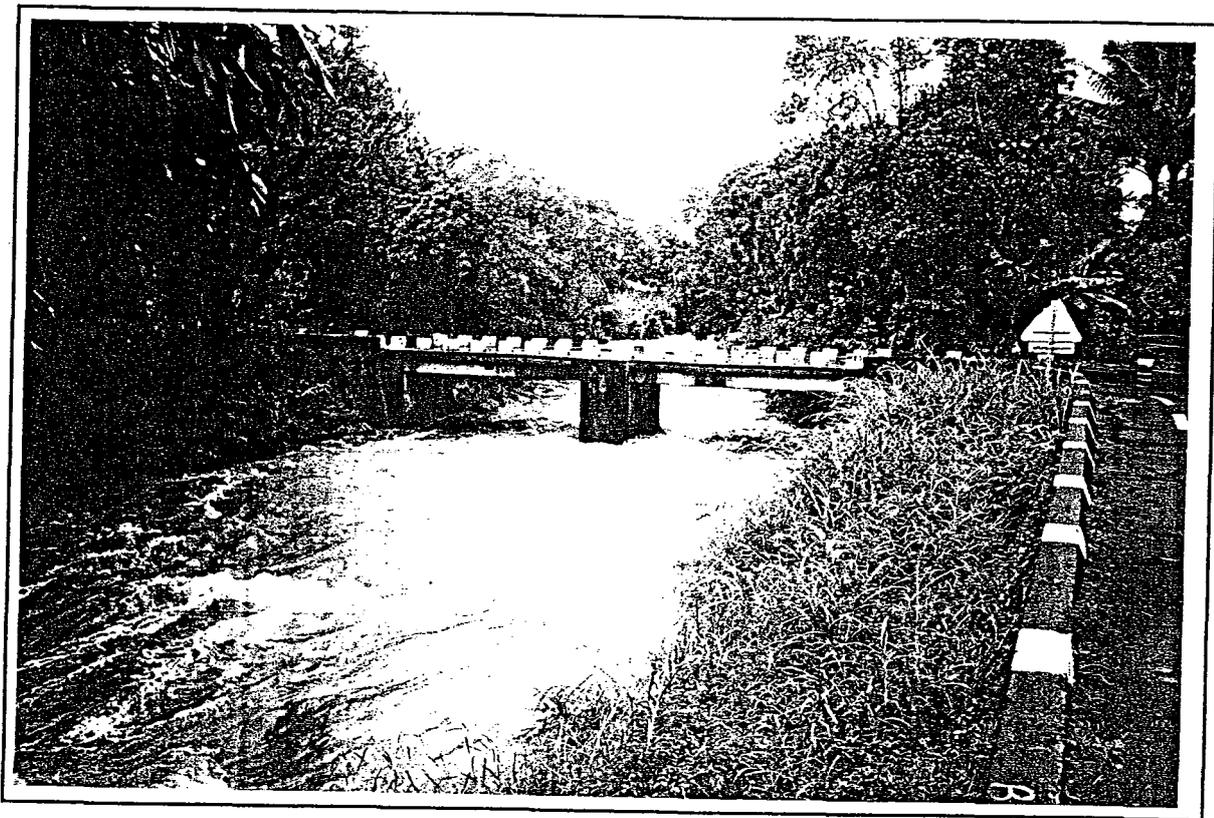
Crue de la Ravine Bras Mussard au droit de l'ouvrage de la RD 54
